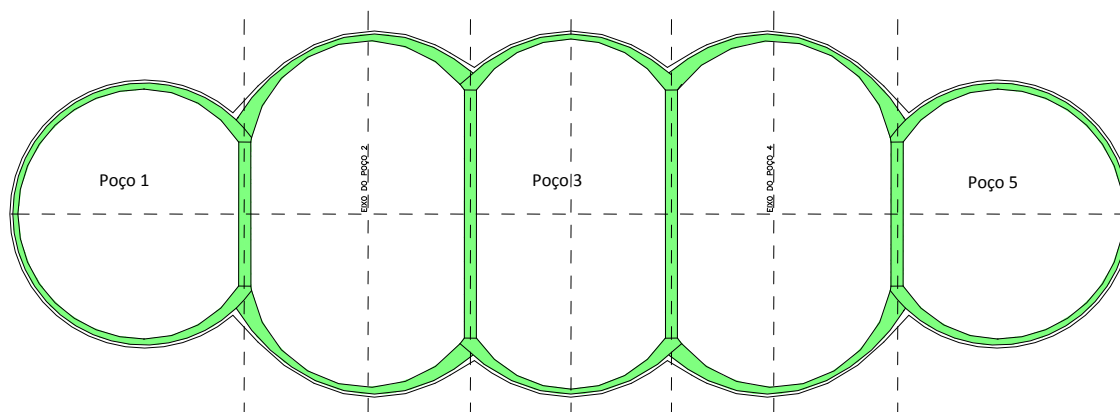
Planta do corpo dos poços da estação da Reboleira (Adaptado CJC 2009).
